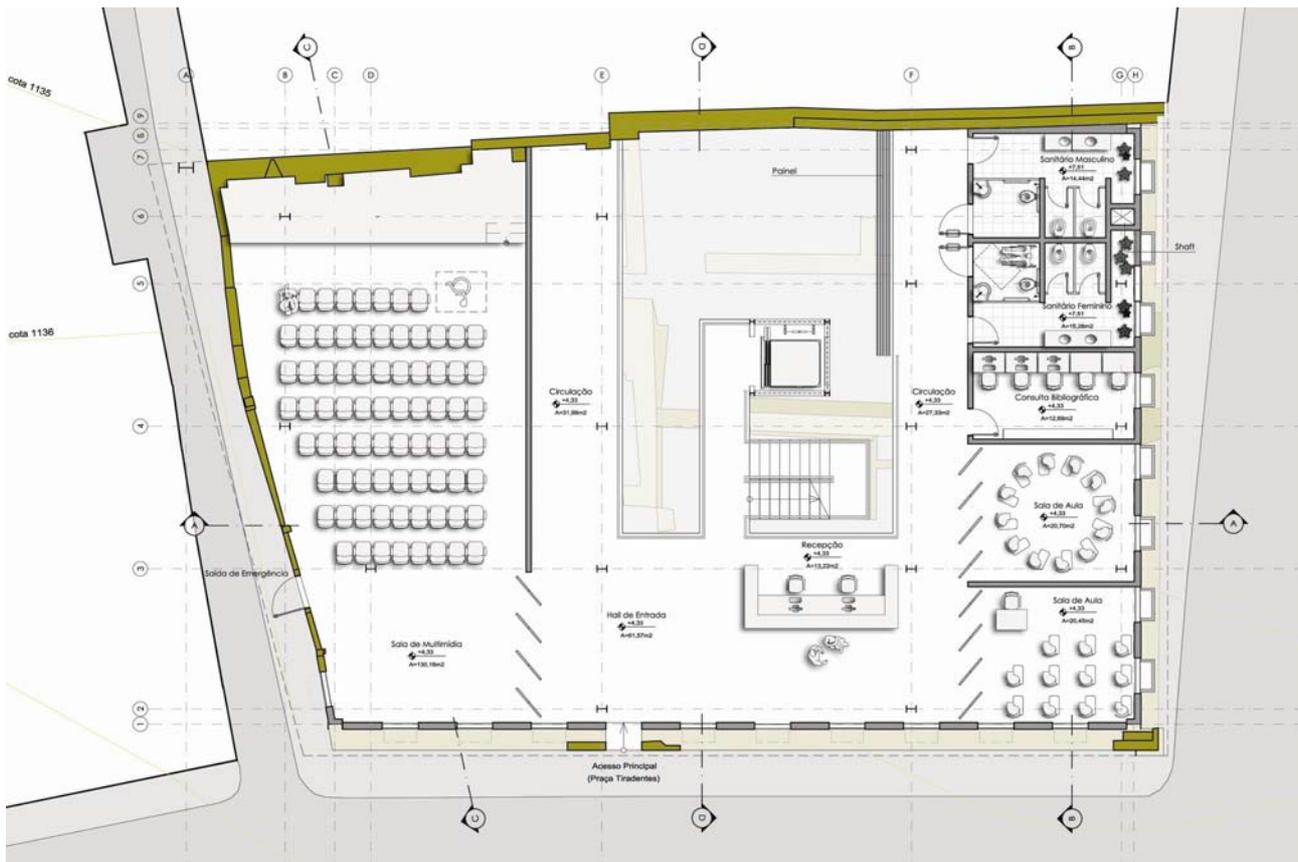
CEPOP, planta baixa do nível da Praça Tiradentes.
